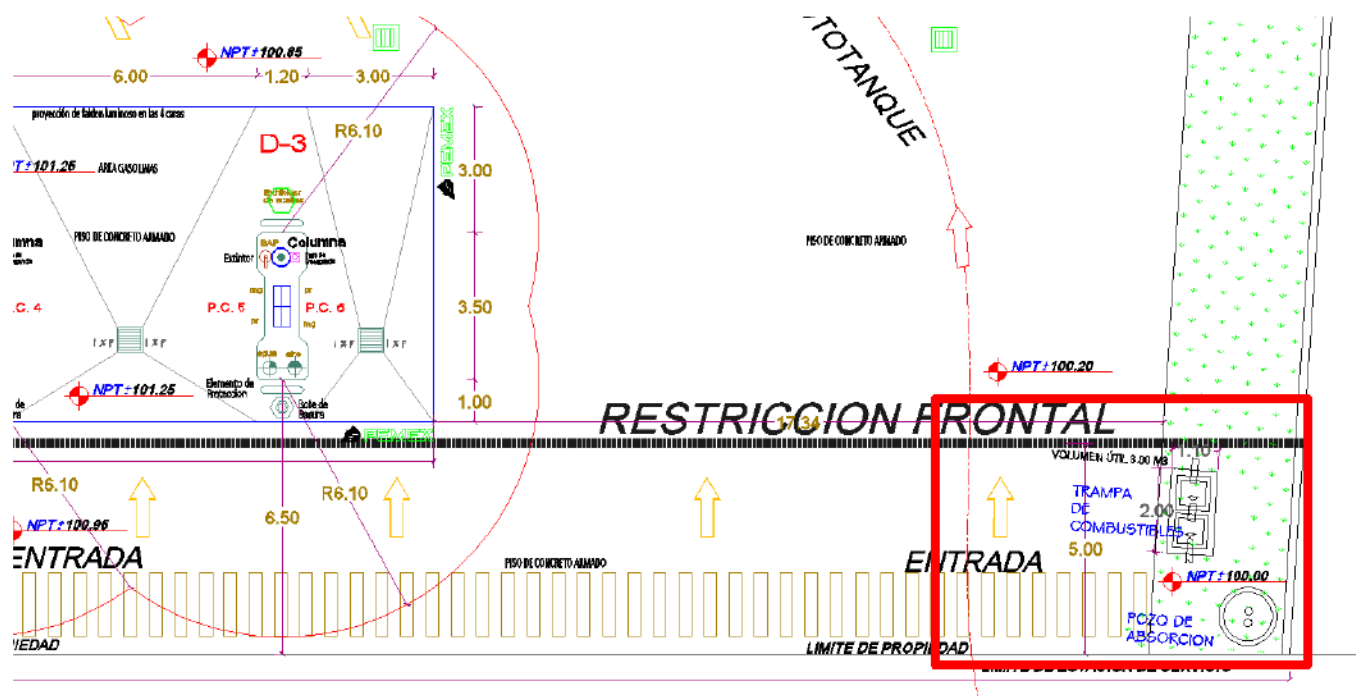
Características de la red de drenaje pluvial y de agua aceitosa en la estación, los detalles se pueden apreciar en el plano ubicado en los anexos.
